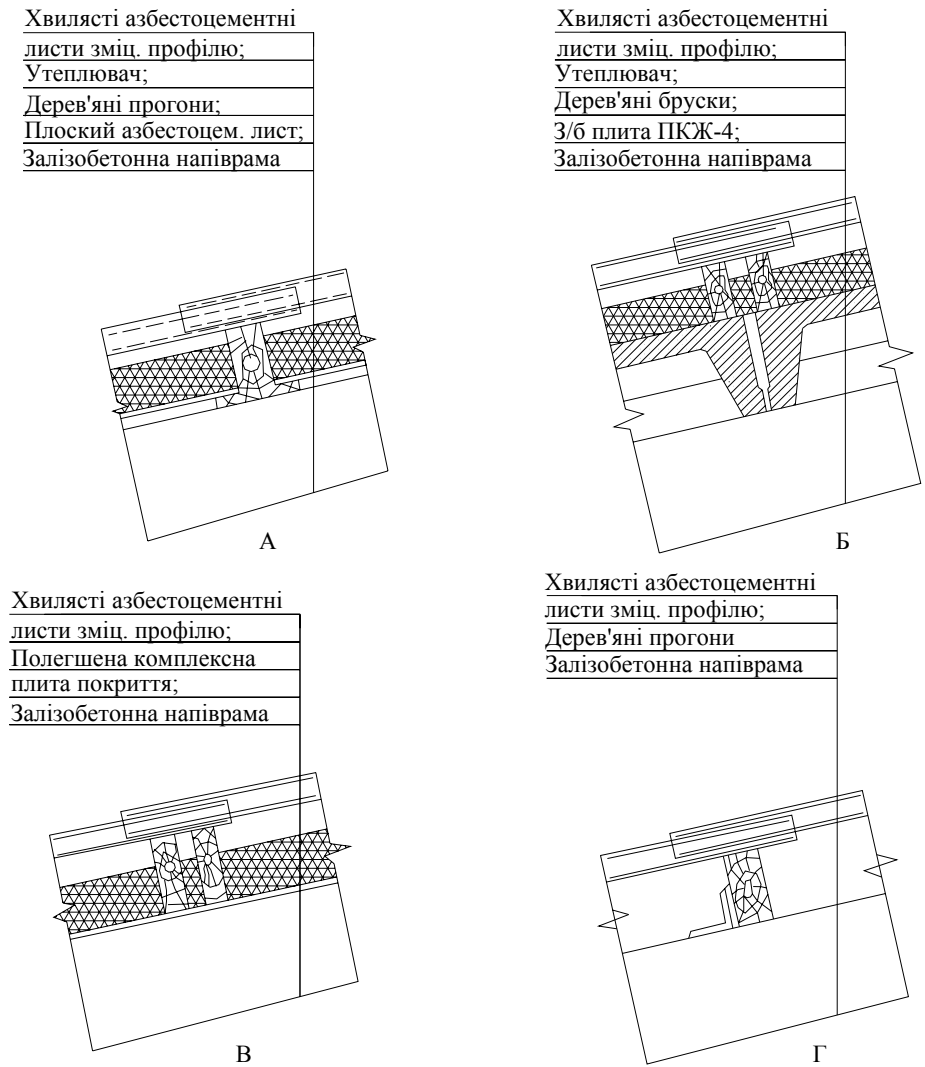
Варіанти покриття: а-прогони, тепле покриття; б-покриття із залізобетонними плитами; в-покриття з полегшеними плитами; г-прогони, холодне покриття
